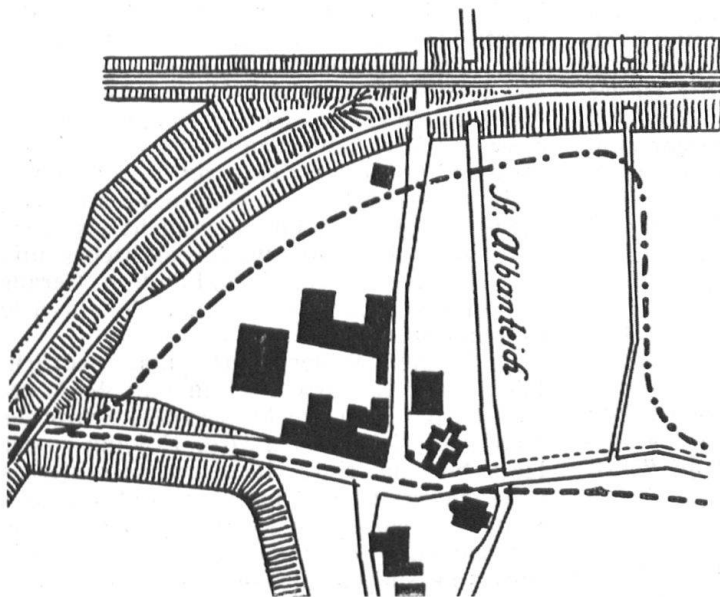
Lageplan von St. Jakob a. d. Birs. ----- Linienführung des neuen Trams nach dem Projekt der Strassenbahnverwaltung. - - - - - Schema für eine Linienführung, welche die Erhaltung des schönen Platzbildes sichern würde. — Fig. 20. Plan de St-Jacques-sur-la-Birse avec le projet du tracé officiel du tramway et un tracé laissant intacte la place.
